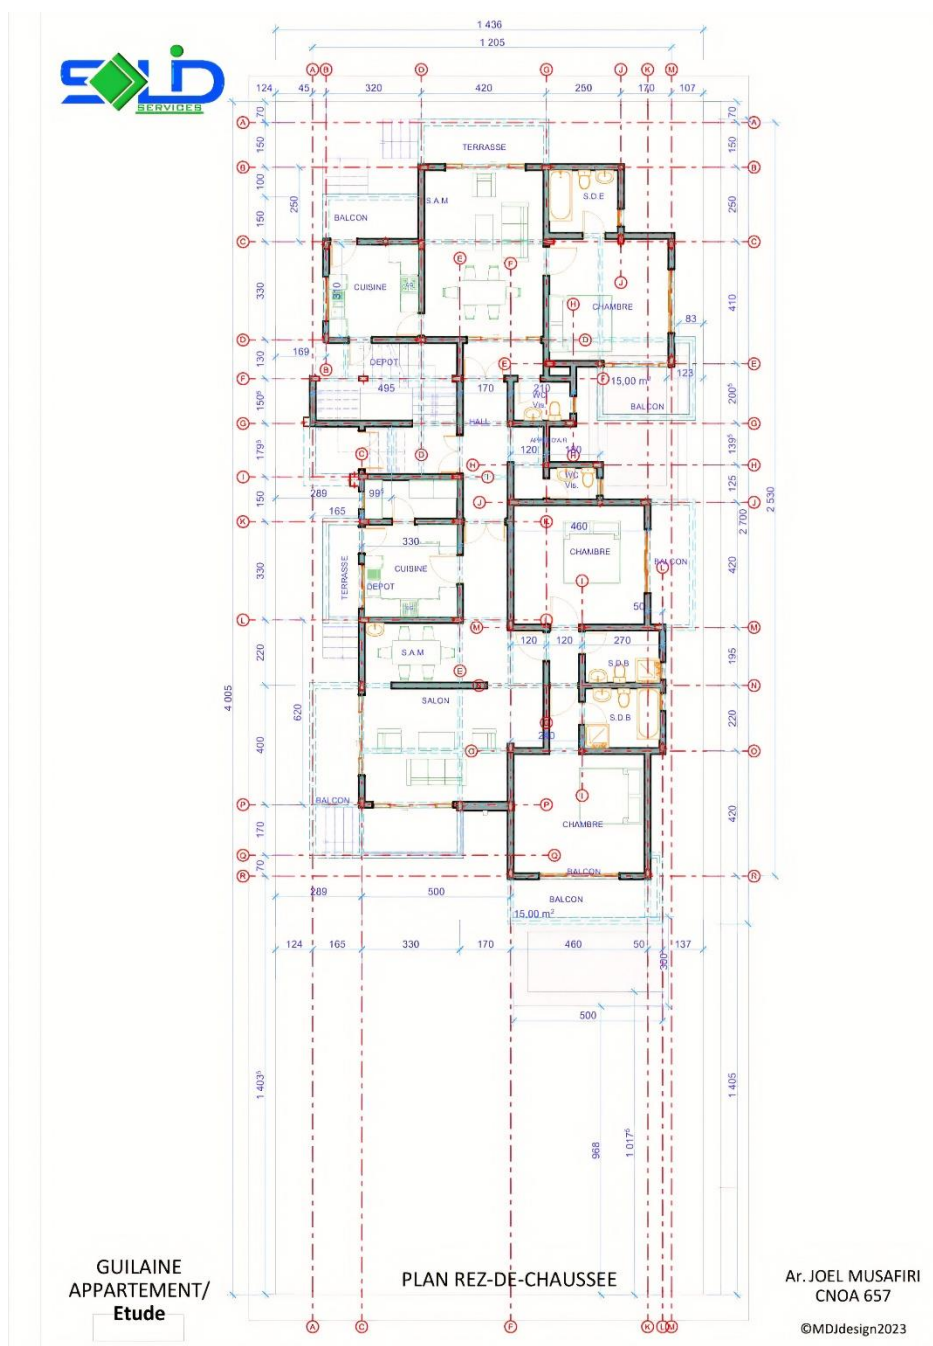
Figure Plan rez-de-chaussée avec indication de l'emplacement de poteau
